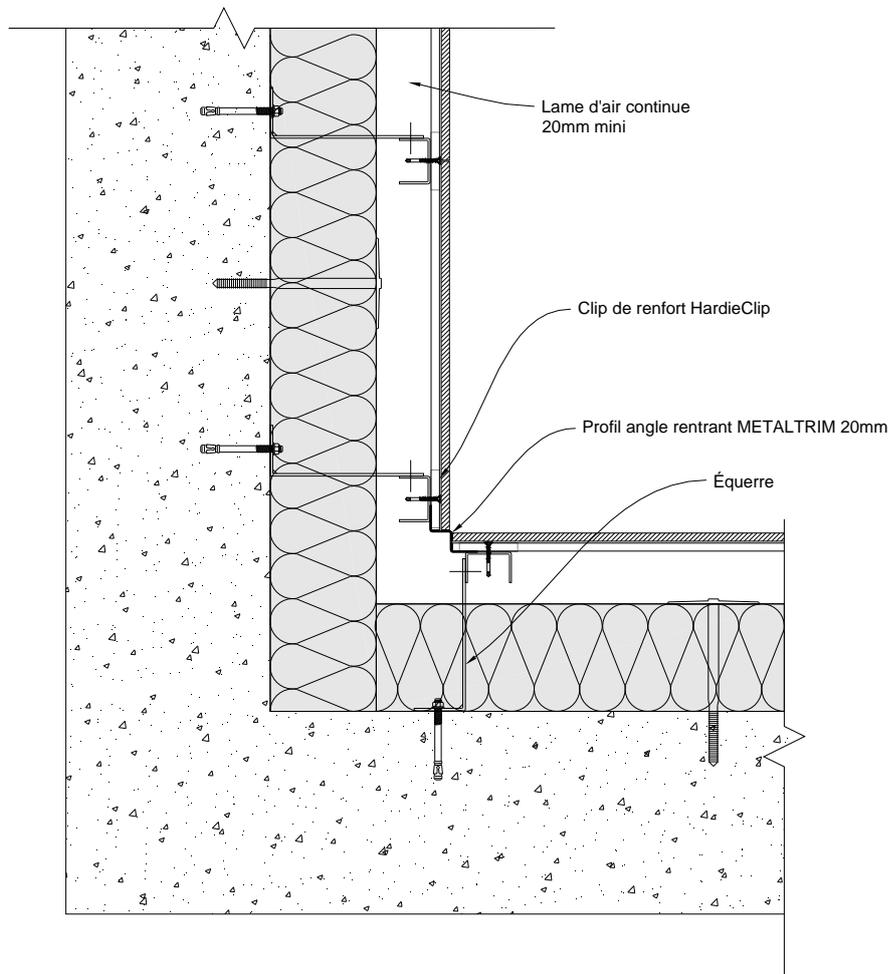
Angle rentrant sur ossature acier - Clins horizontaux (Coupe horizontale)
